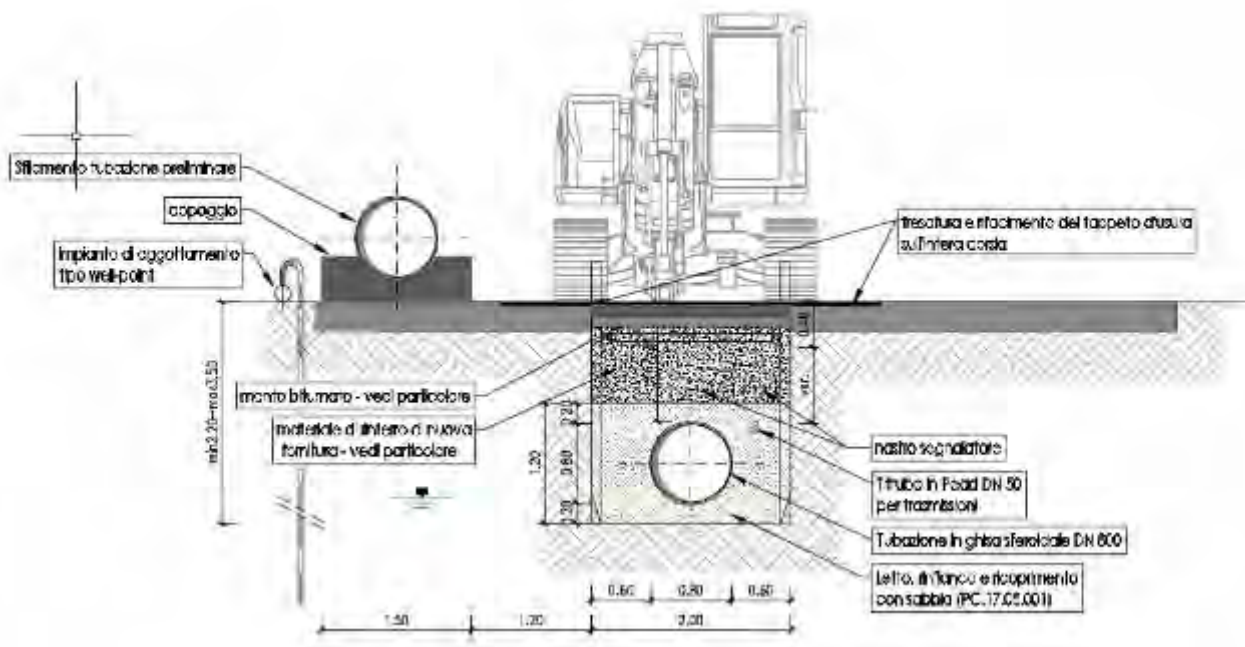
Sezione tipo 4 di scavo e di posa su strada provinciale
